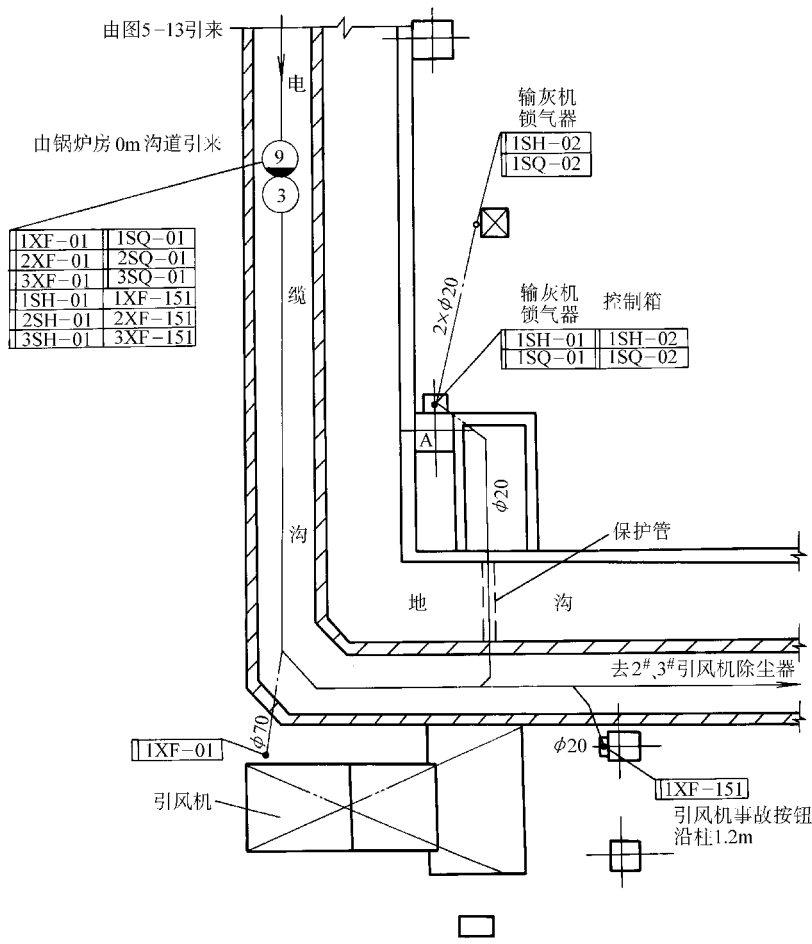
引风机、除尘器场地电缆敷设平面图（局部）
